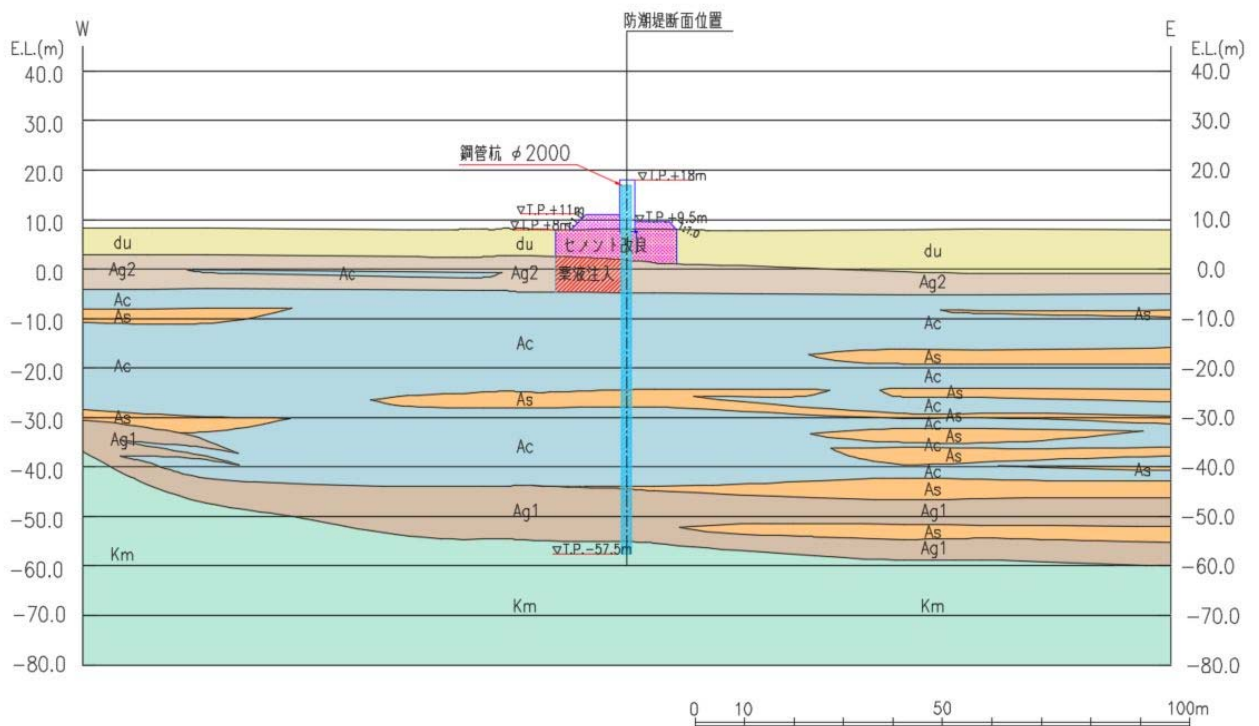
11. 5—21 (4) 鋼管杭鉄筋コンクリート防潮壁 断面図 (断面④)
